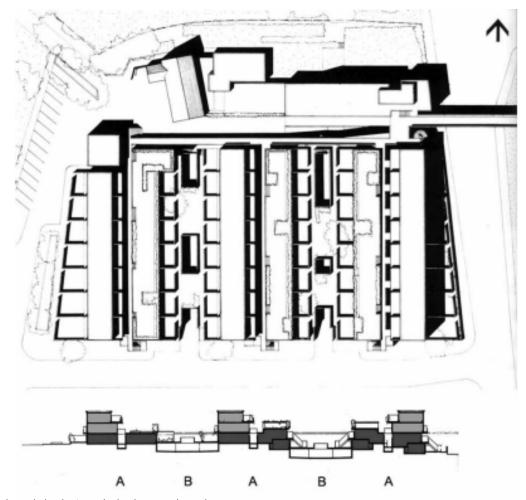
Imágen de la planimetría de Fleet Road. Mark Swenarton.
